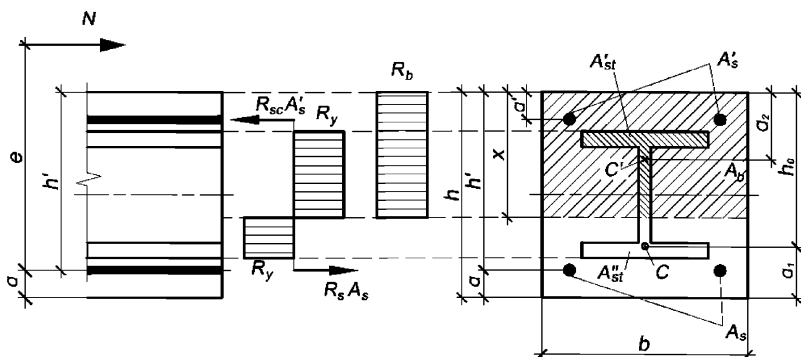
Схема усилий и эпюры напряжений в сечении, нормальном к продольной оси внецентренно сжатого сталежелезобетонного элемента
